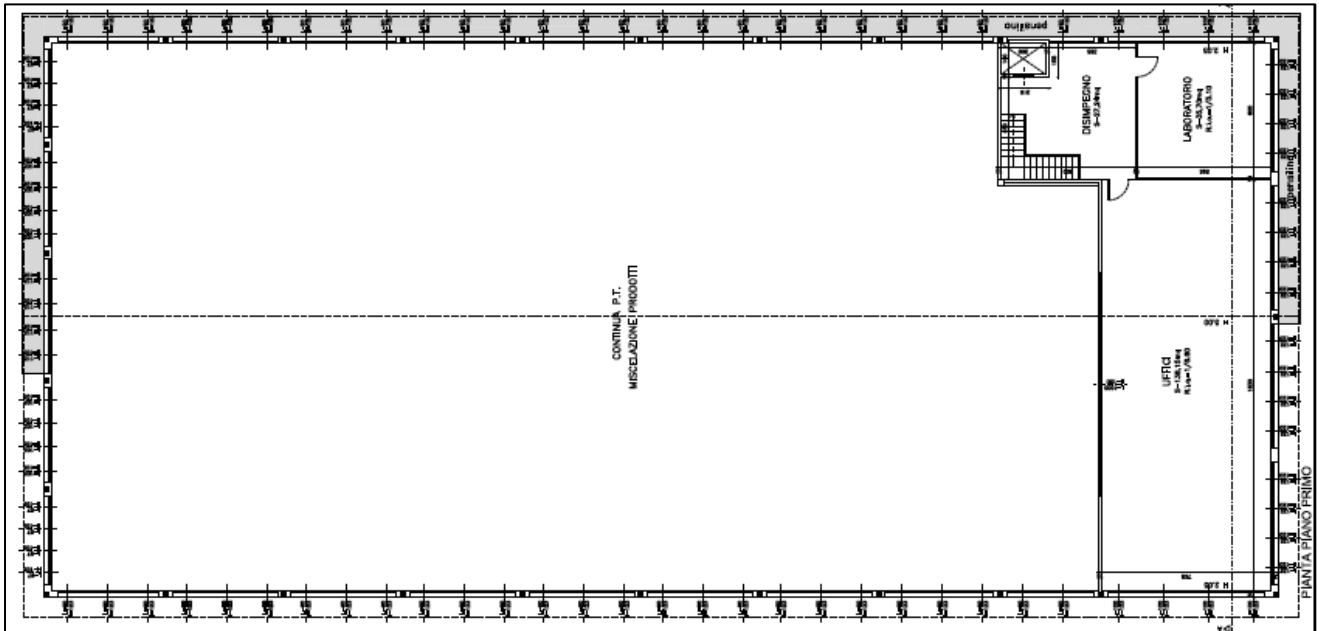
Planimetria stato di progetto Piano Primo (estratto tavola n.6 – progetto piante)
